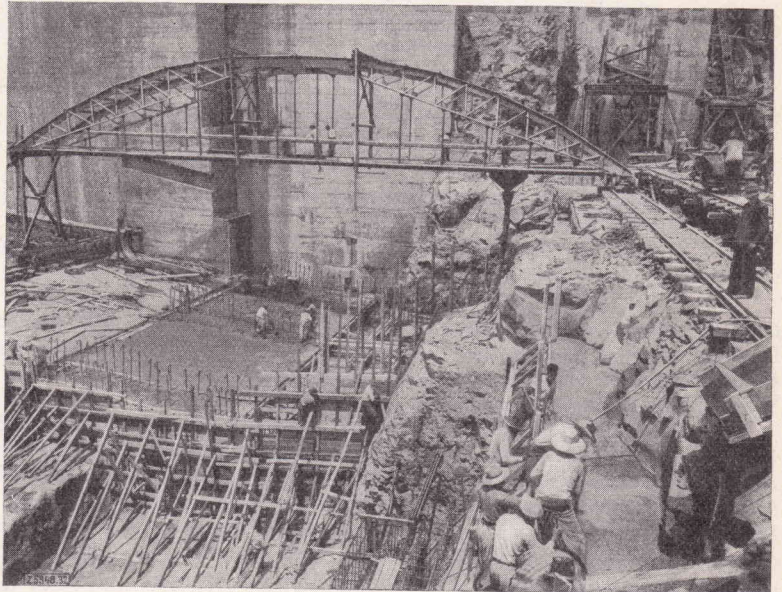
Betonierung der Turbinensohle mittels fahrbarer Betonierbrücke.
